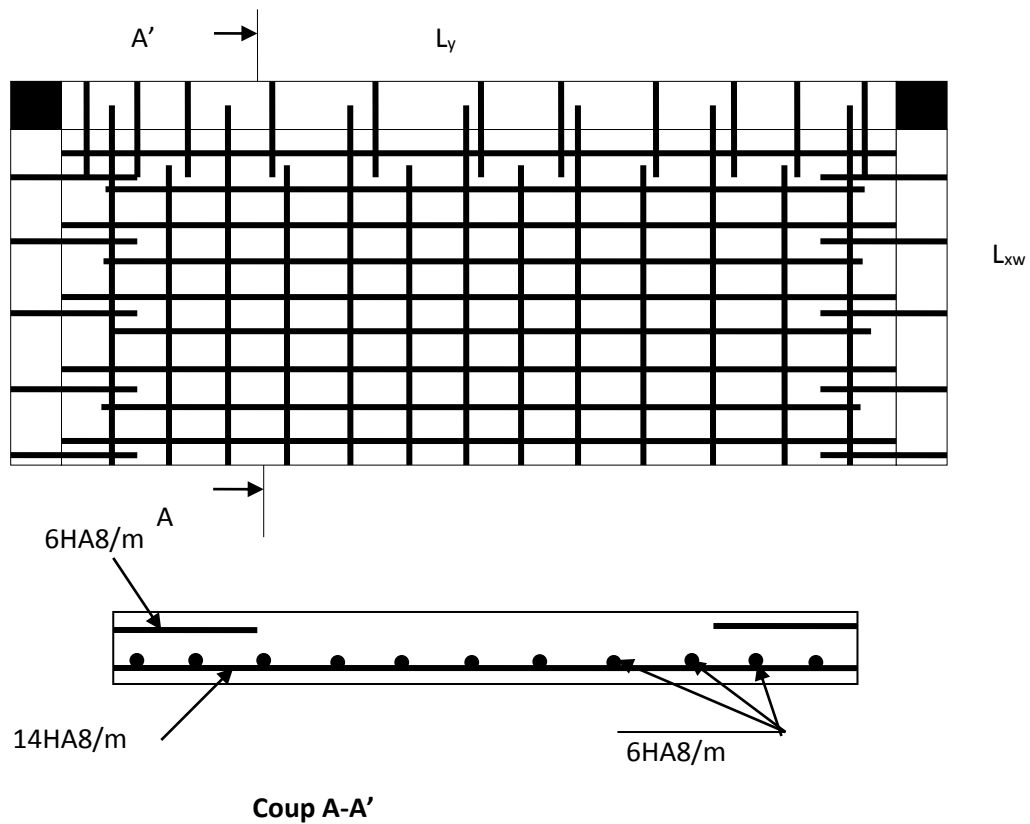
Schéma de ferrailage de la dalle pleine Sur trois appuis
